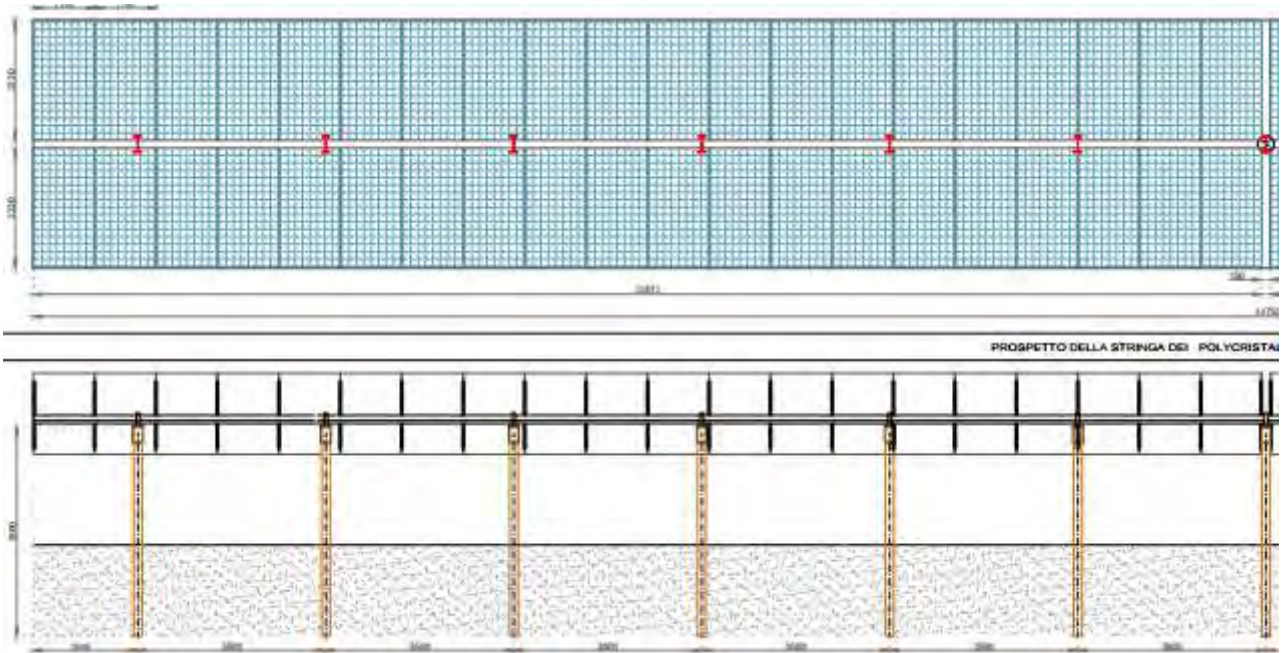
Stralcio della pianta e del prospetto della struttura di supporto.
